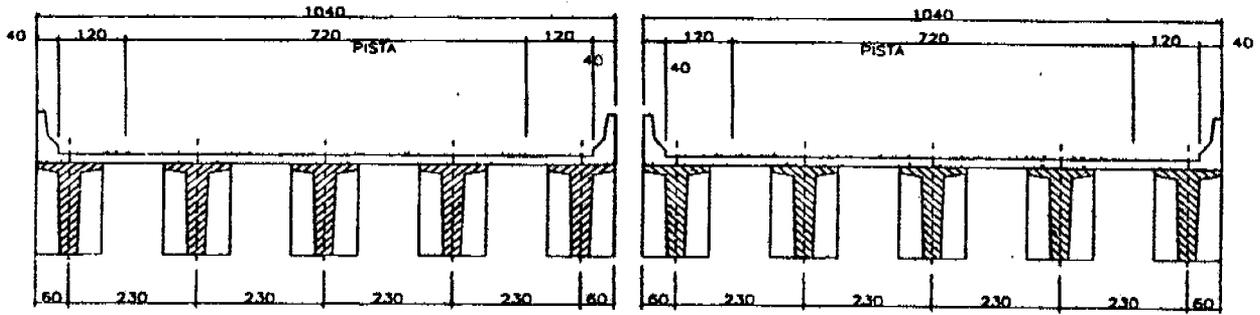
Secciones típicas para puentes con largos mayores que 60m
